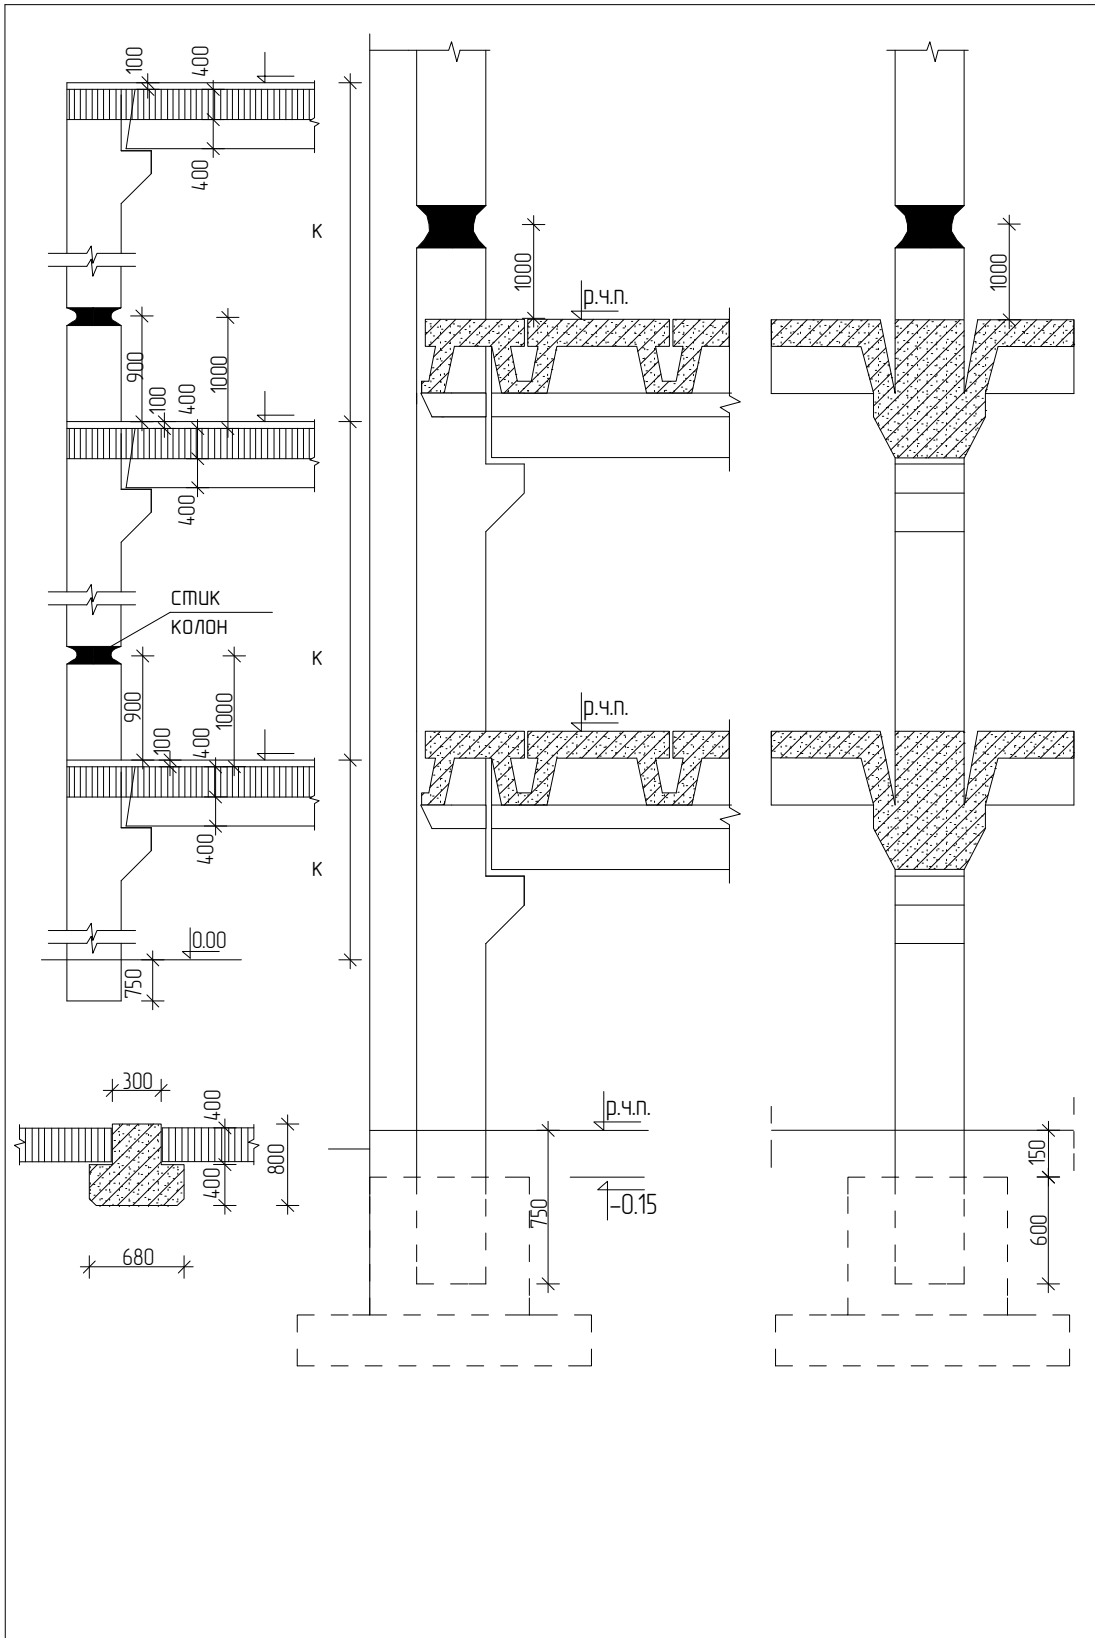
Висотна ув'язка уніфікованих багатоповерхових промислових будівель з сіткою колон 6×6 і 9×6 м. Розміщення стиків колон і габарити закладення їх у фундаментні блоки, коли плити перекриття розташовуються зверху ригелів
